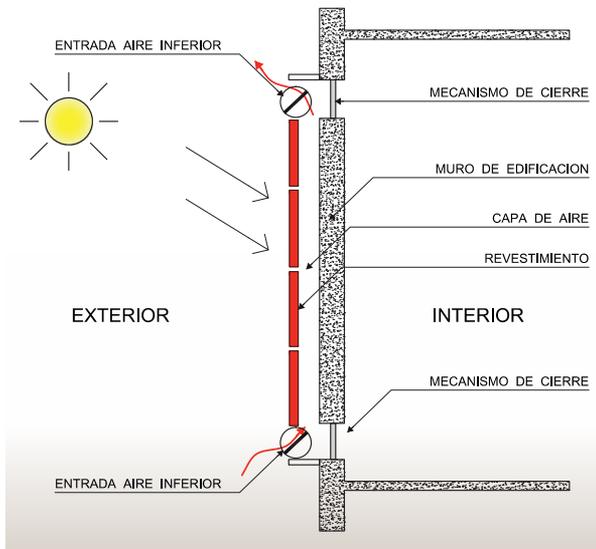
Detalle de cámara de aire de fachada ventilada.
